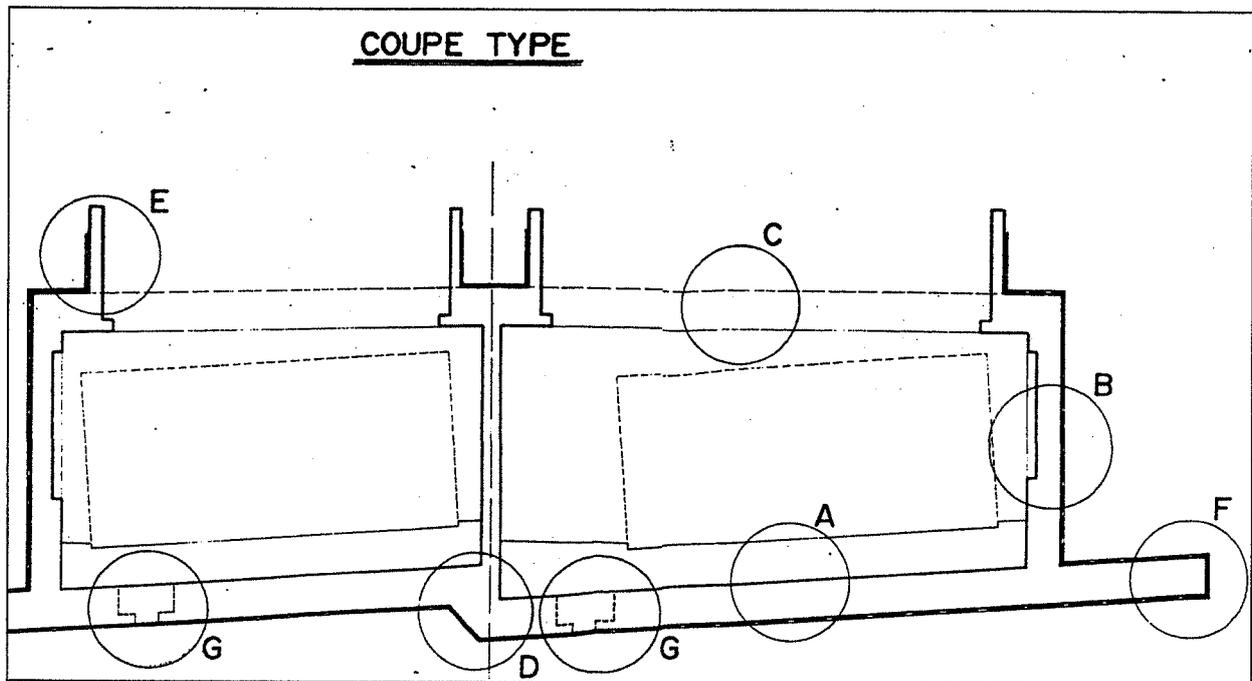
Querschnitt mit Abdichtung, Detail A bis F.
